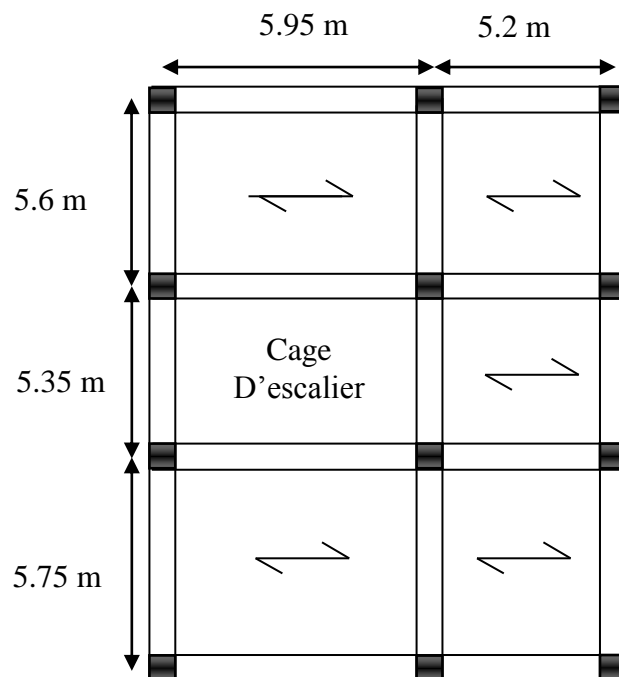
Sens de la disposition des poutrelles du 7em, 8em étage et terrasse accessible
